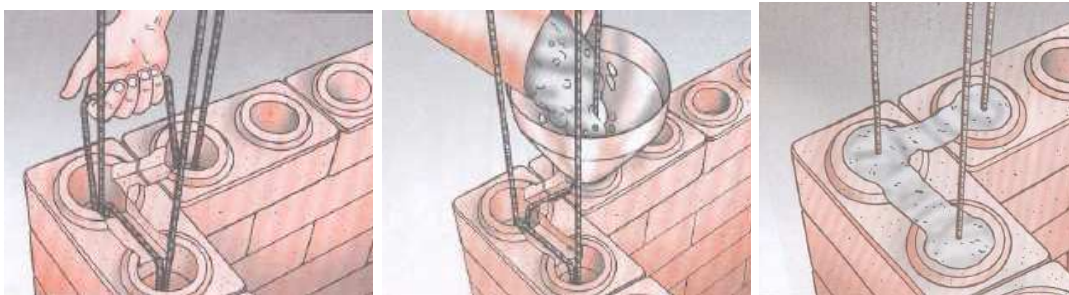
Execução da amarração dos cantos na alvenaria de tijolo de solo-cimento
